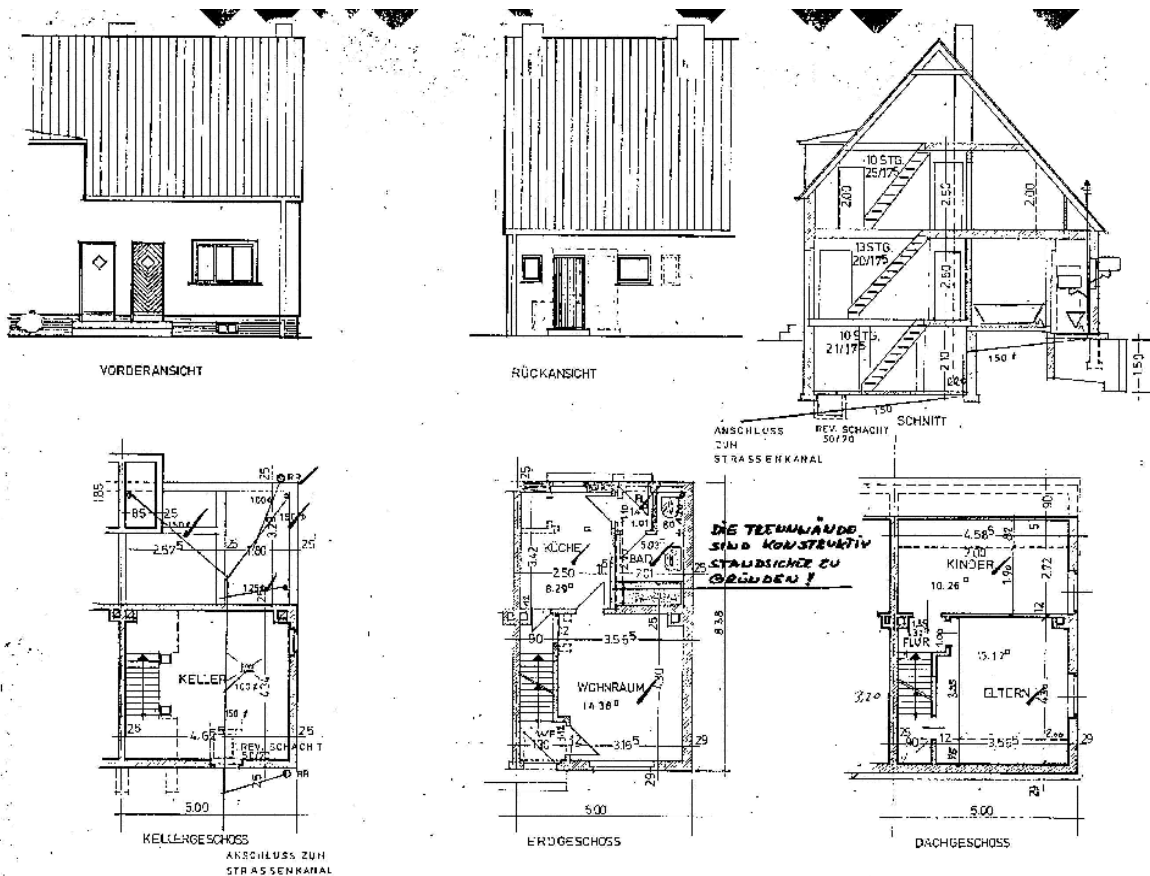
Grundriss, Ansicht und Schnitt einer Wohneinheit des Vierhaustyps
